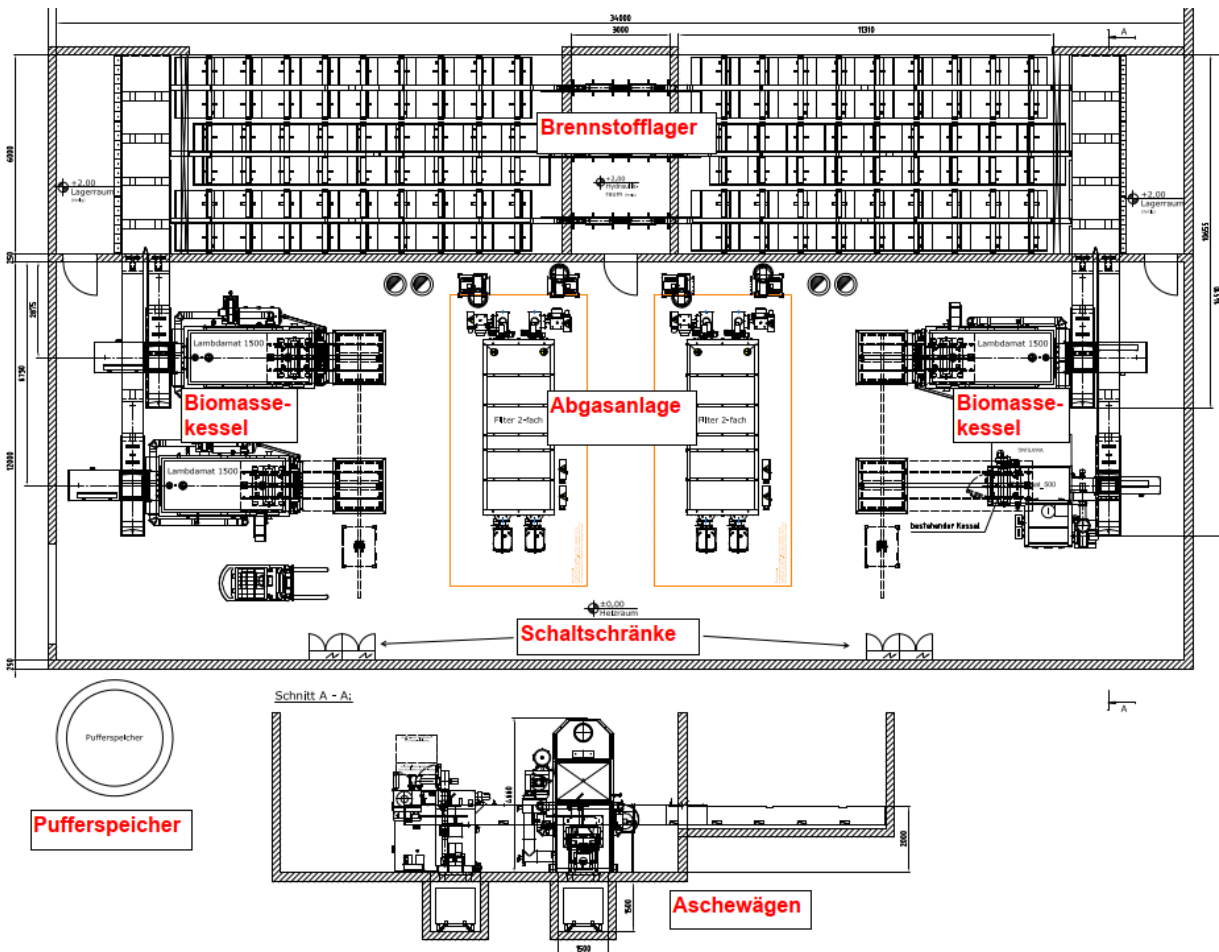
Beispielhafter Grundriss einer Heizzentrale für eine Holzhackschnitzelanlage (Quelle: Fröhring)
